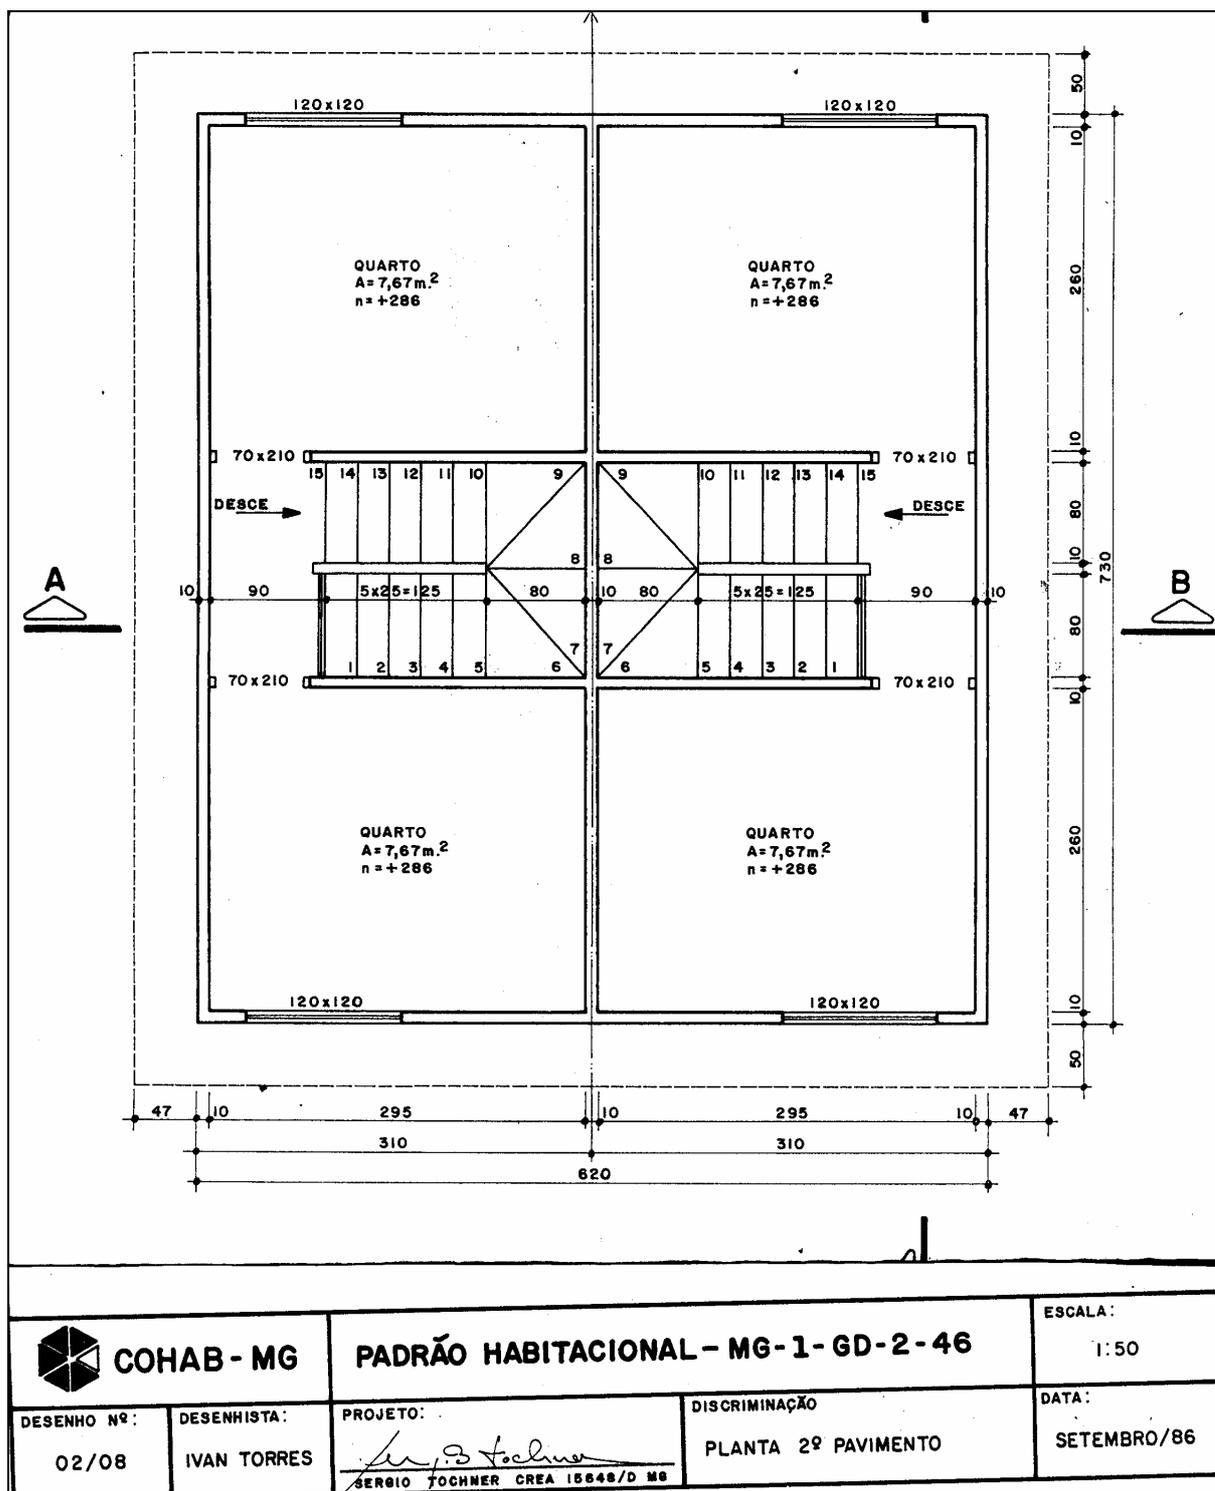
PLANTA BAIXA - "PREDINHO" SEGUNDO PISO
